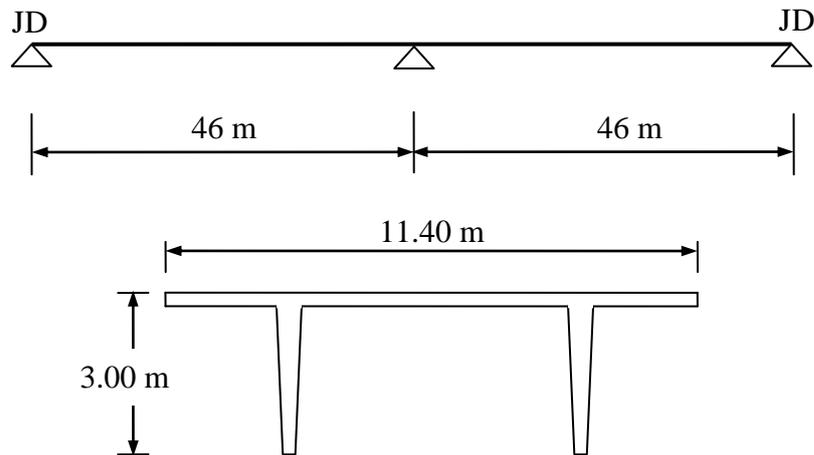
Esquema estático de las vigas del sector C del Puente General Artigas (tramo típico representativo de vanos 13 a 46)
